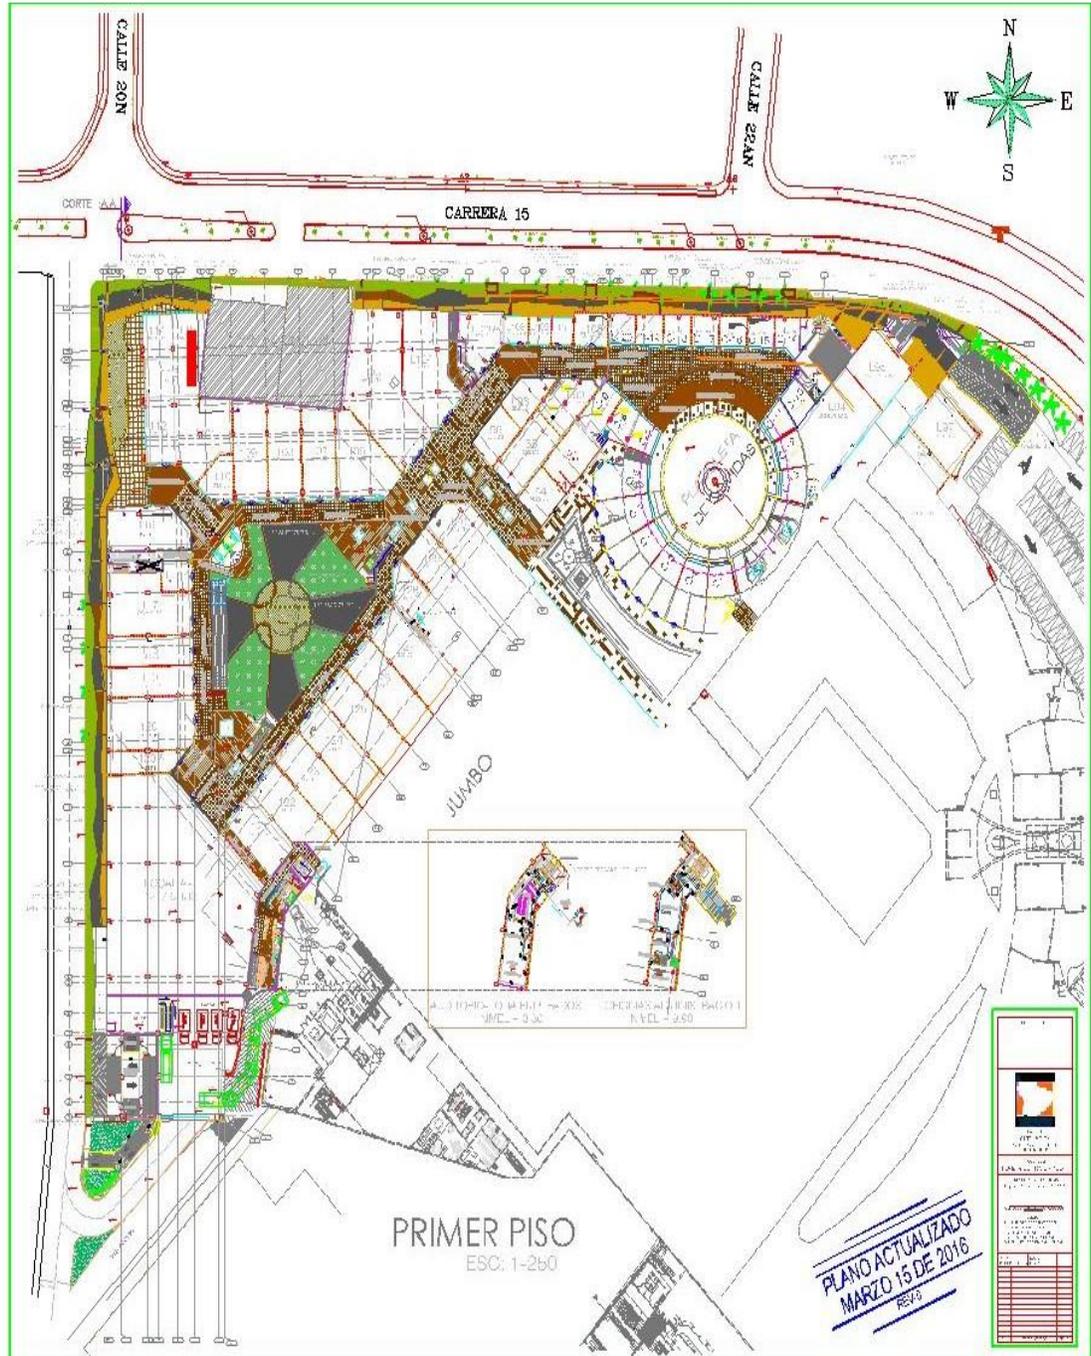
Planta Arquitectónica primer piso. (Fuente: Diseños Arquitectónicos ARINSA).
